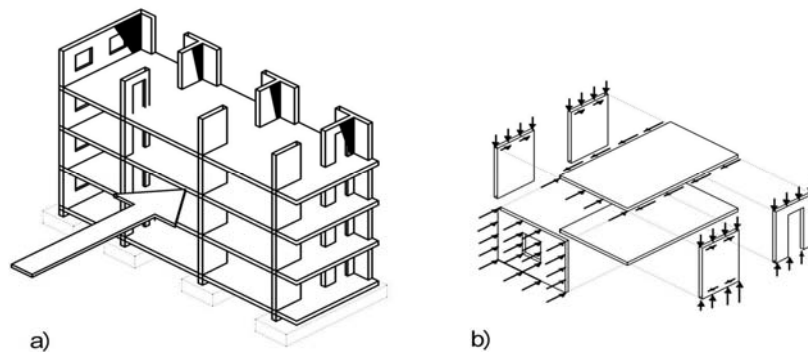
Gebäude mit Wand- und Deckenscheiben
